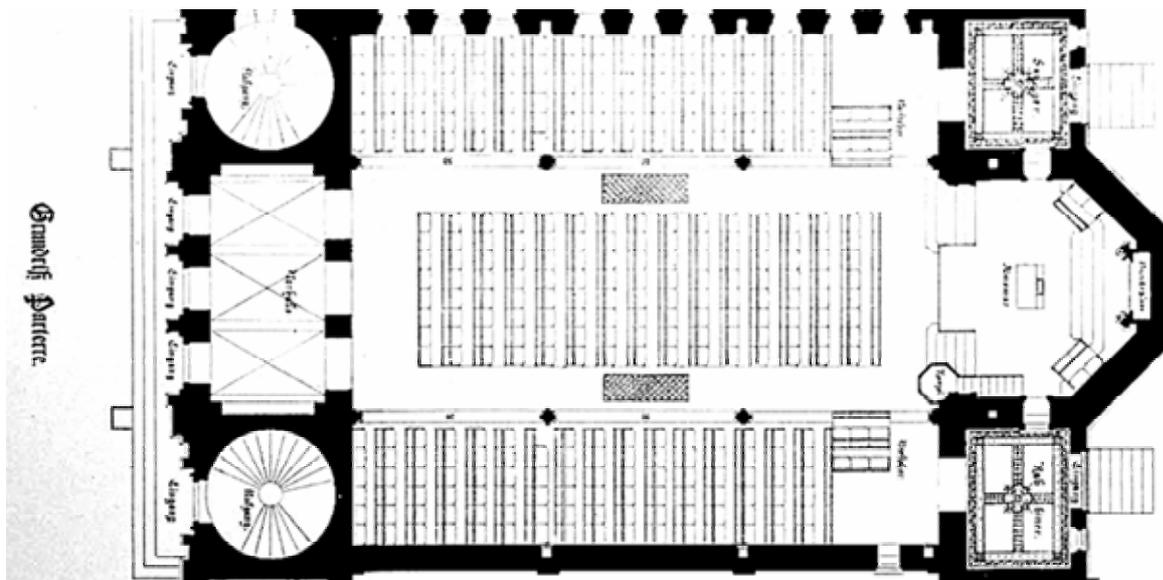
Grundriss auf Erdgeschossebene
